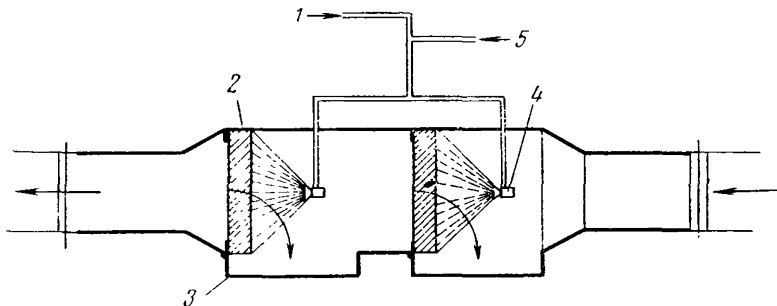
Пылеосаждение в вентиляционной трубе для отработанного воздуха:
